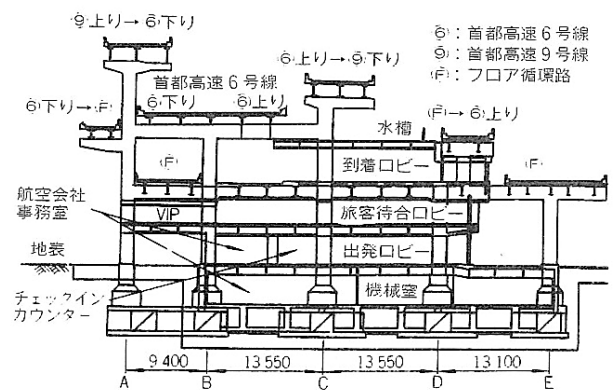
箱崎 JCT 及び東京シティ・エアターミナル断面図 [3]
